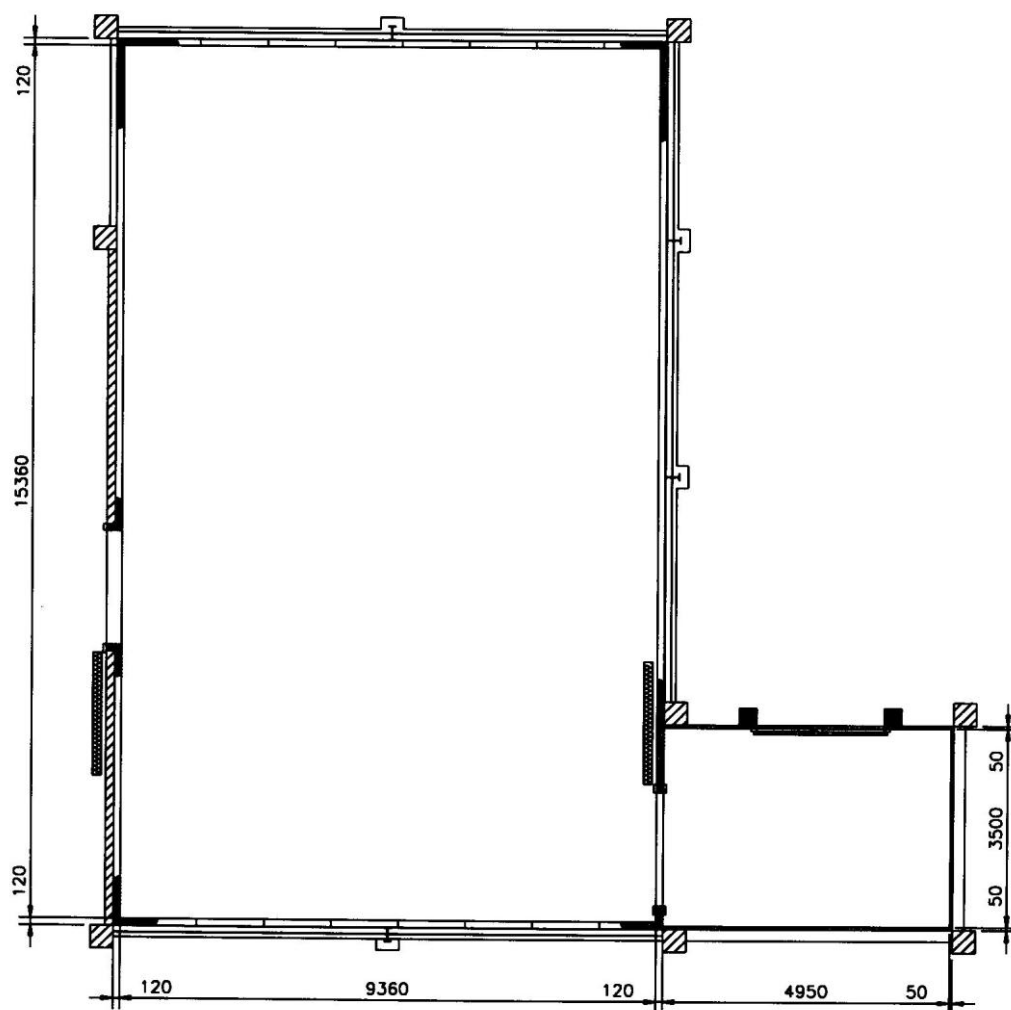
Ilustração da planta baixa de uma câmara fria.
